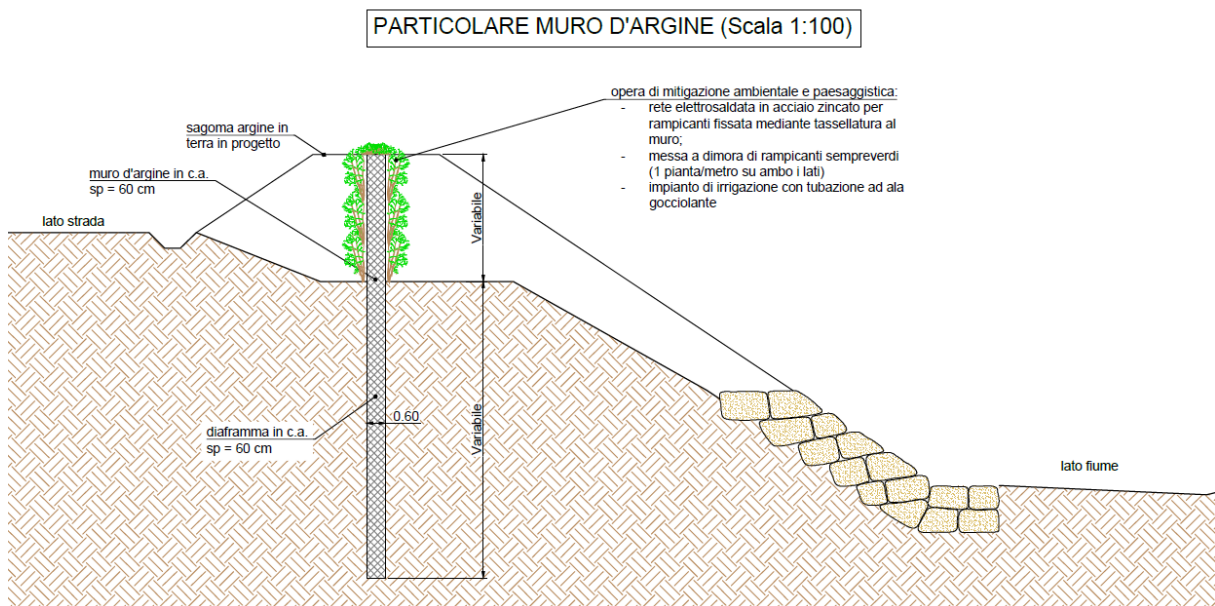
Particolare muro d'argine su diaframma in c.a. progetto generale
